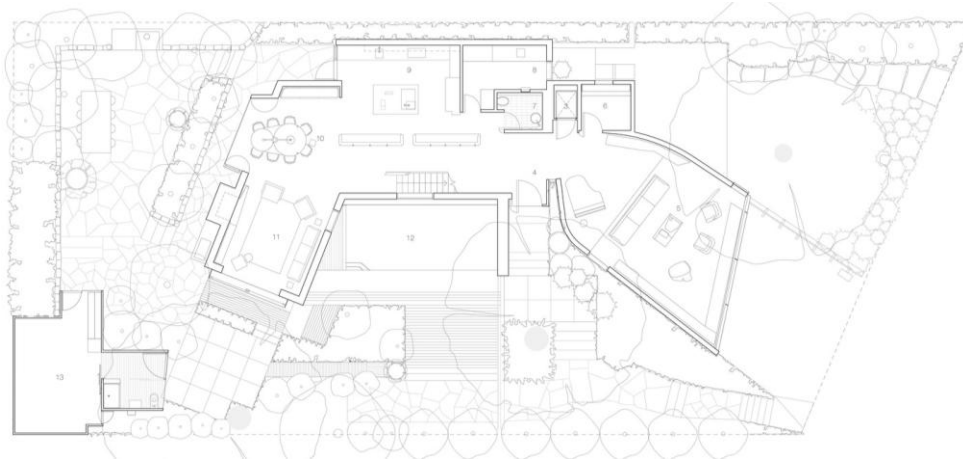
Planta do piso 0, Kew House. Fonte: ArchDaily, Autores: John Wardle Architects
